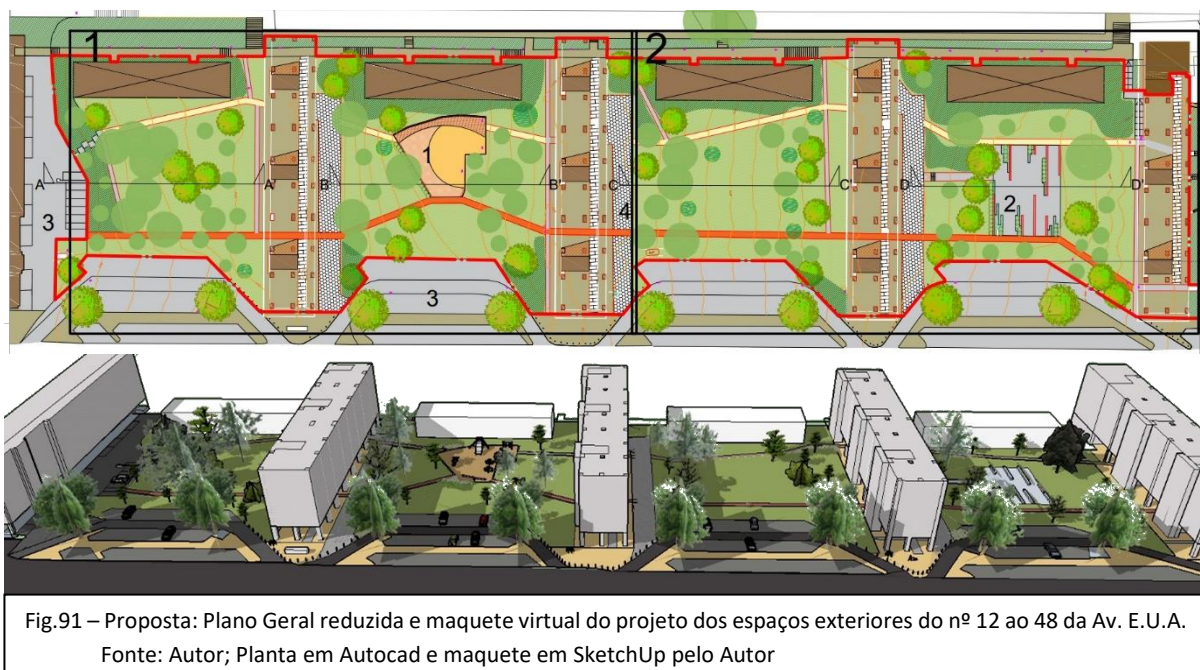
Proposta: Plano Geral reduzida e maquete virtual do projeto dos espaços exteriores do nº 12 ao 48 da Av. E.U.A.
